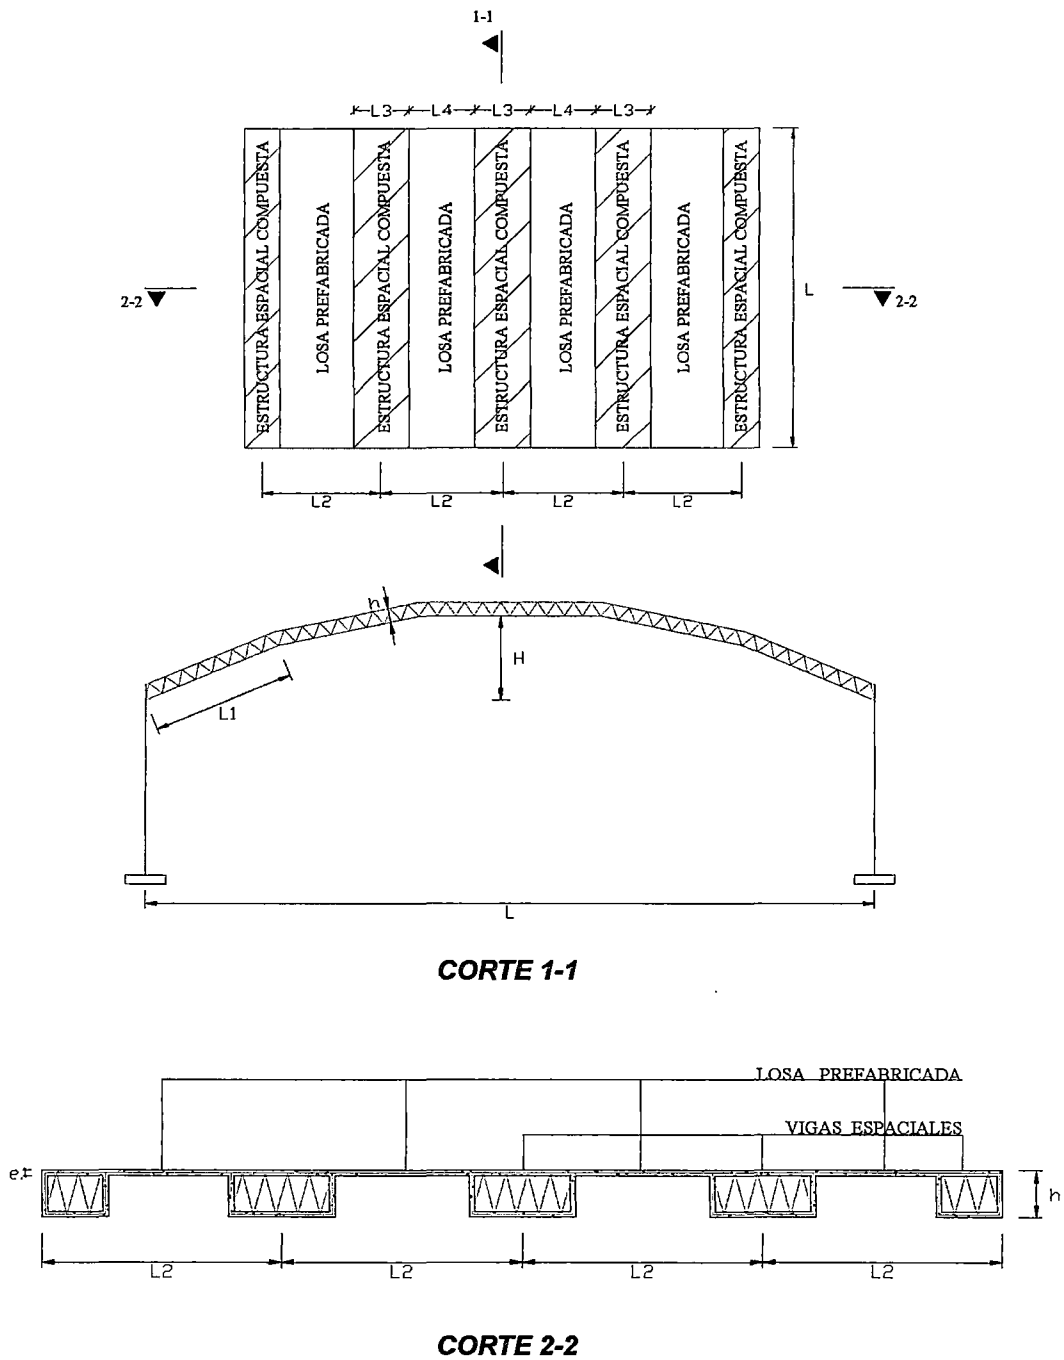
Vista en Planta, Elevación y Detalles Típicos de un Techo Poligonal
